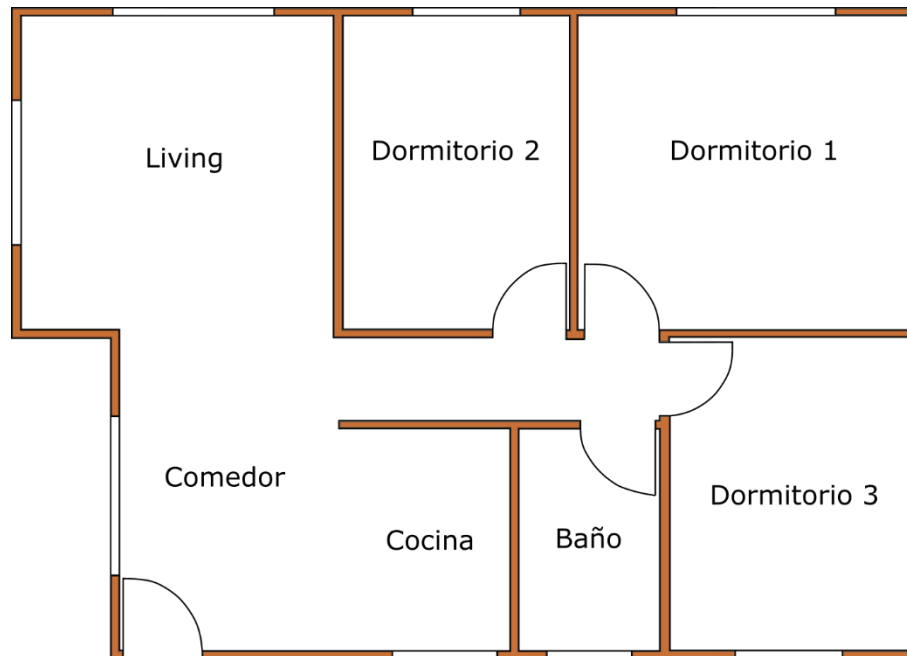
Tipología vivienda aislada de madera. Fuente: Elaboración propia.
